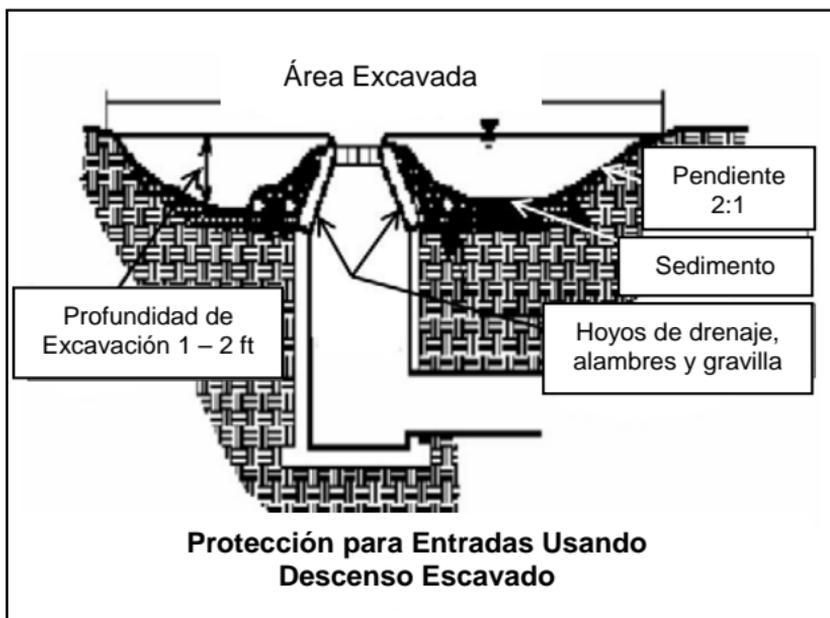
Vista de protección de entradas usando descenso excavado.
